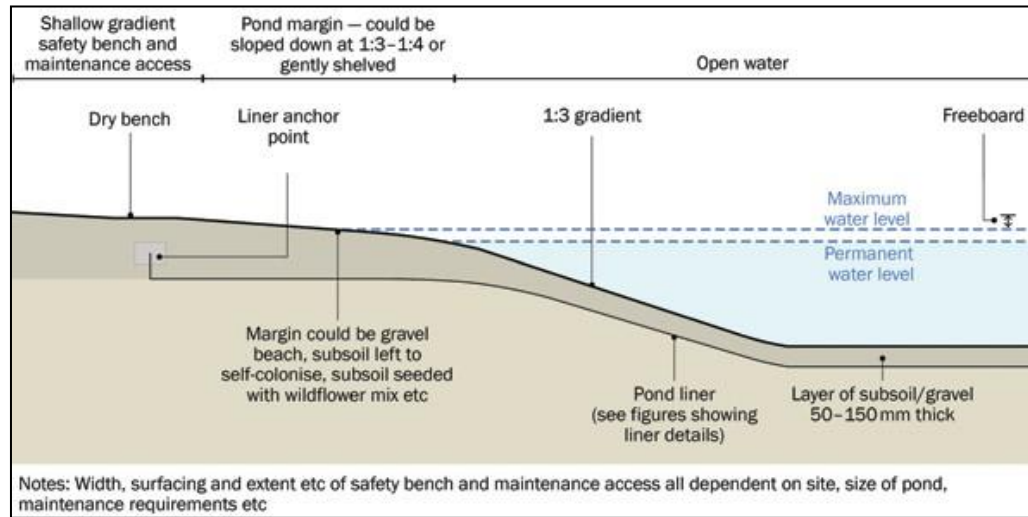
Detalles típicos del borde de la Laguna no plantada
